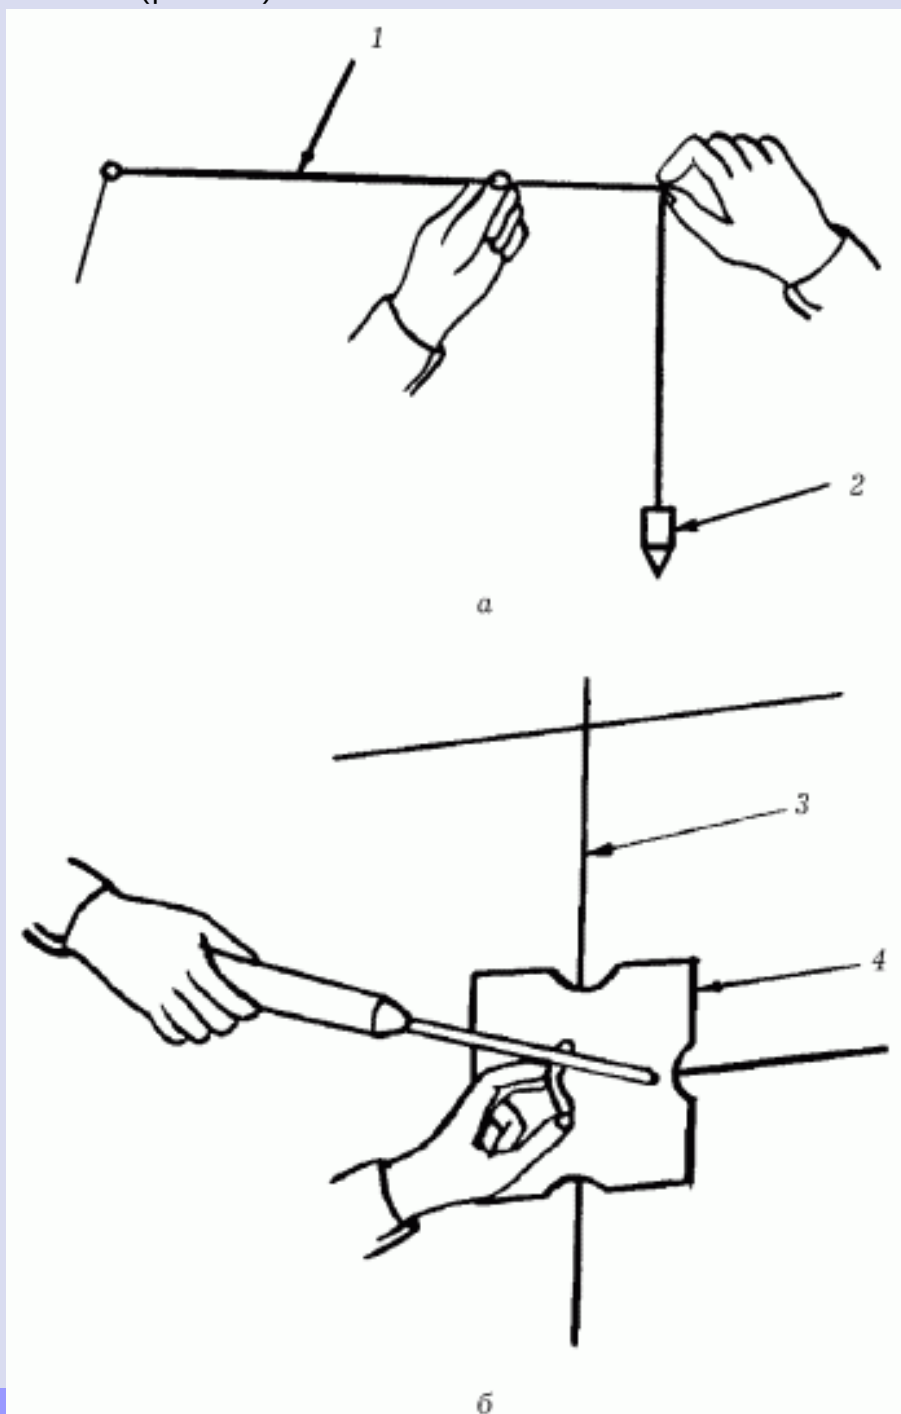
Разметка трассы электропроводки с помощью: а – разметочного шнура с отвесом, б – шаблона: 1 – шнур разметочный; 2 – отвес; 3 – линия (трасса) электропроводки; 4 – шаблон.
